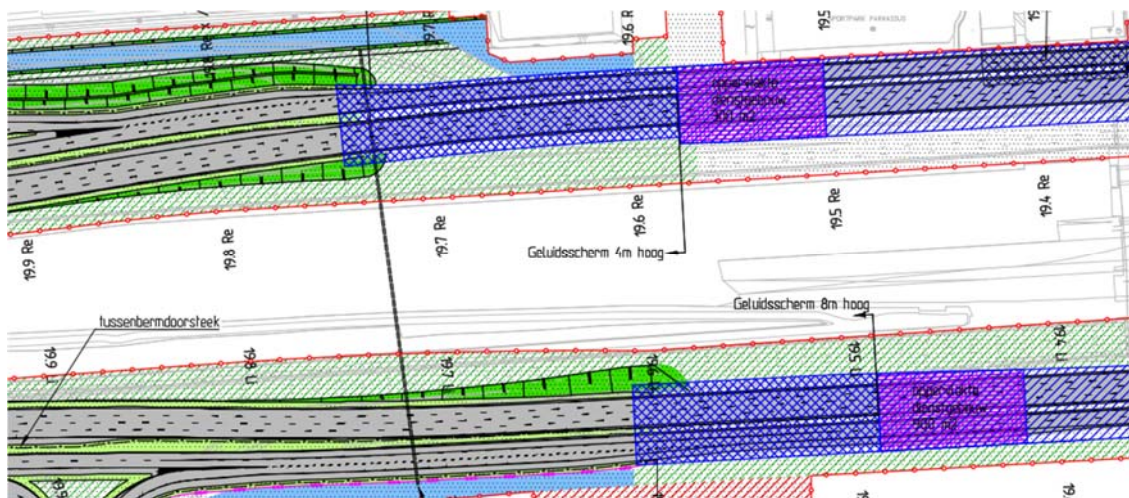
Situatie wTB Zuidelijke tunnelbuis ZW
